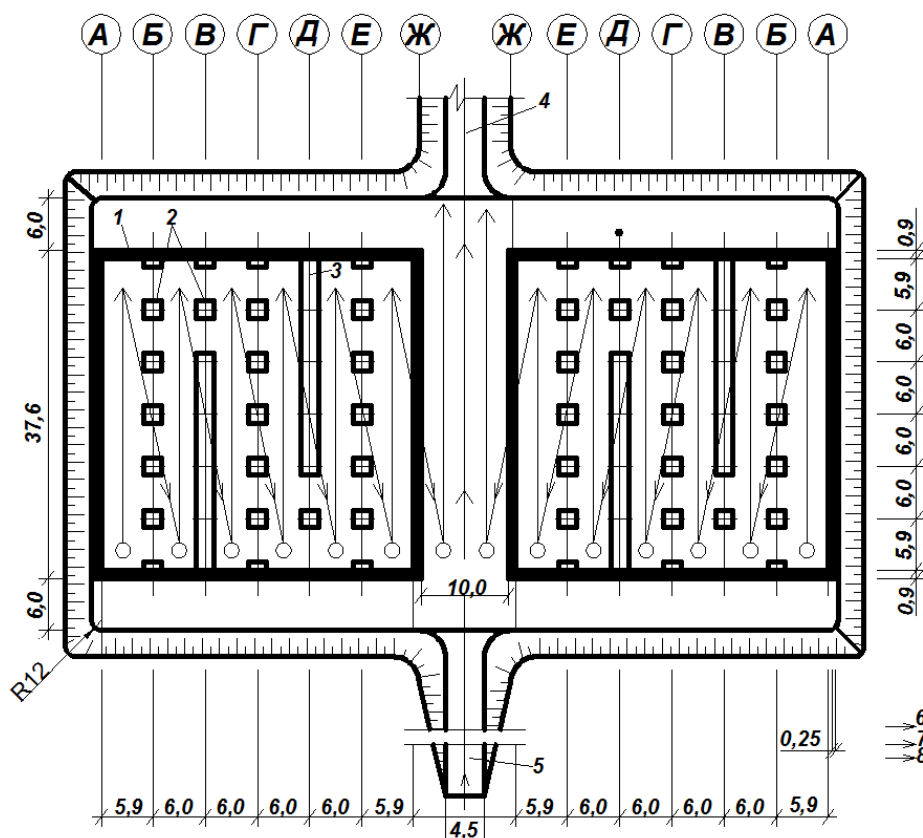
Принципиальная схема монтажа горизонтального отстойника
